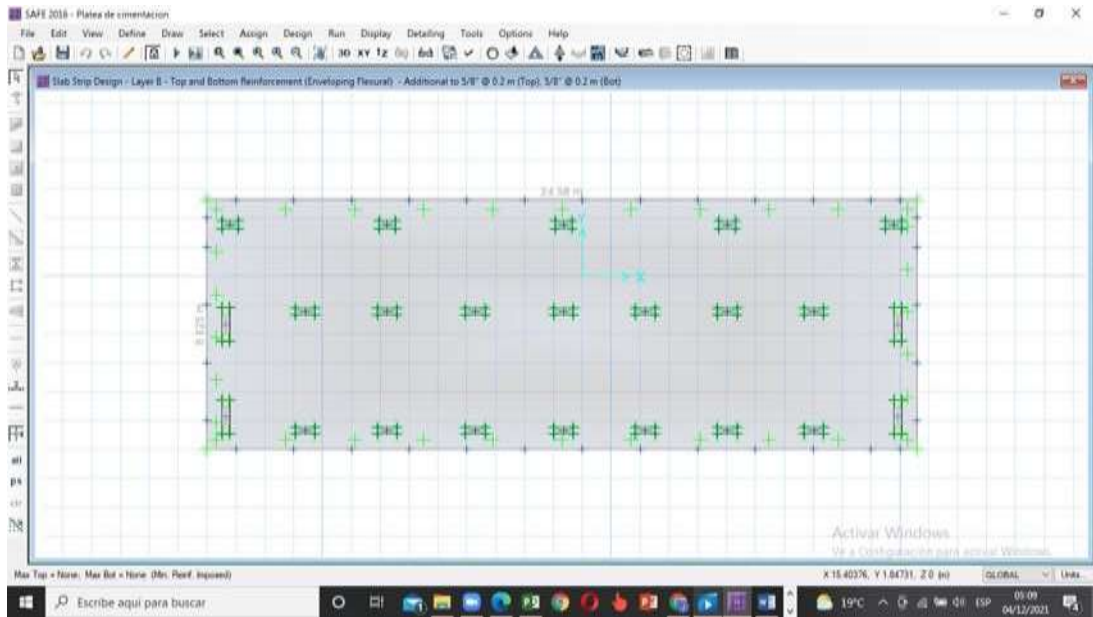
Diseño de losa de cimentación – Refuerzo Y-Y
